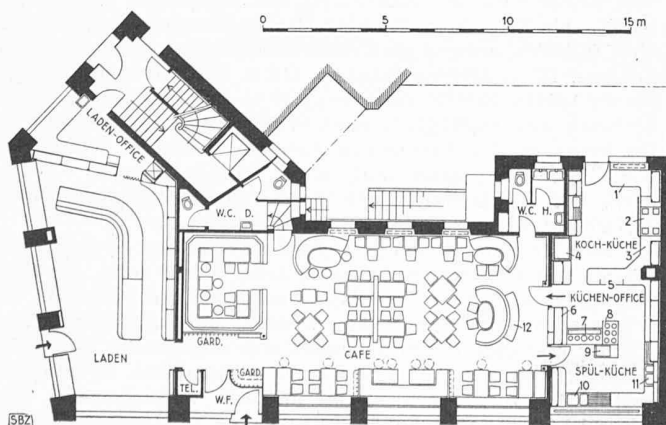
Grundriss 1:300. Legende: 1 Rüsten, 2 Kochen (bestehend Gasherd), 3 Anrichten, 4 Kühlschrank, 5 Wärmeschrank, 6 Getränke, 7 Kaffeemaschine, 8 Glace, 9 Reg.-Kasse, 10 Gläser-spüle, 11 Geschirrspüle, 12 Besteck. — Laden siehe Seite 126
